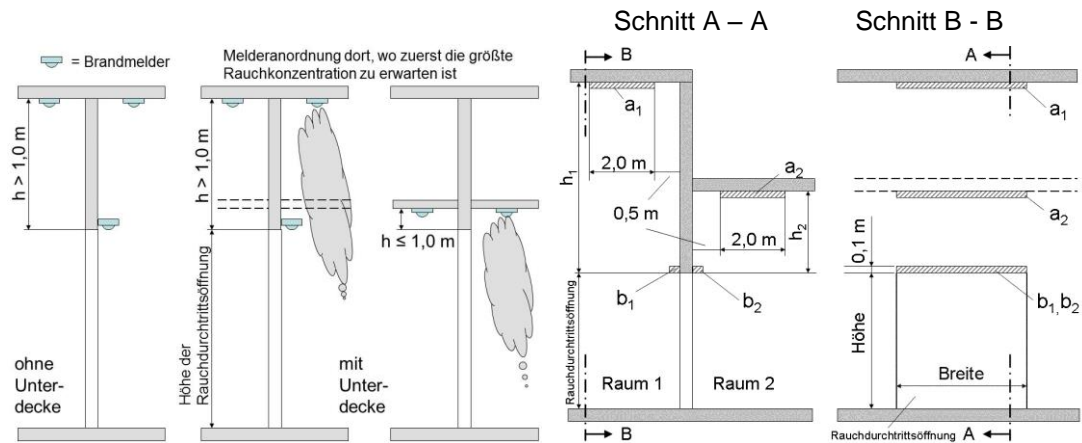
Maßgebende Höhe der Deckenunterfläche    Bild 2: Installationsbereiche
